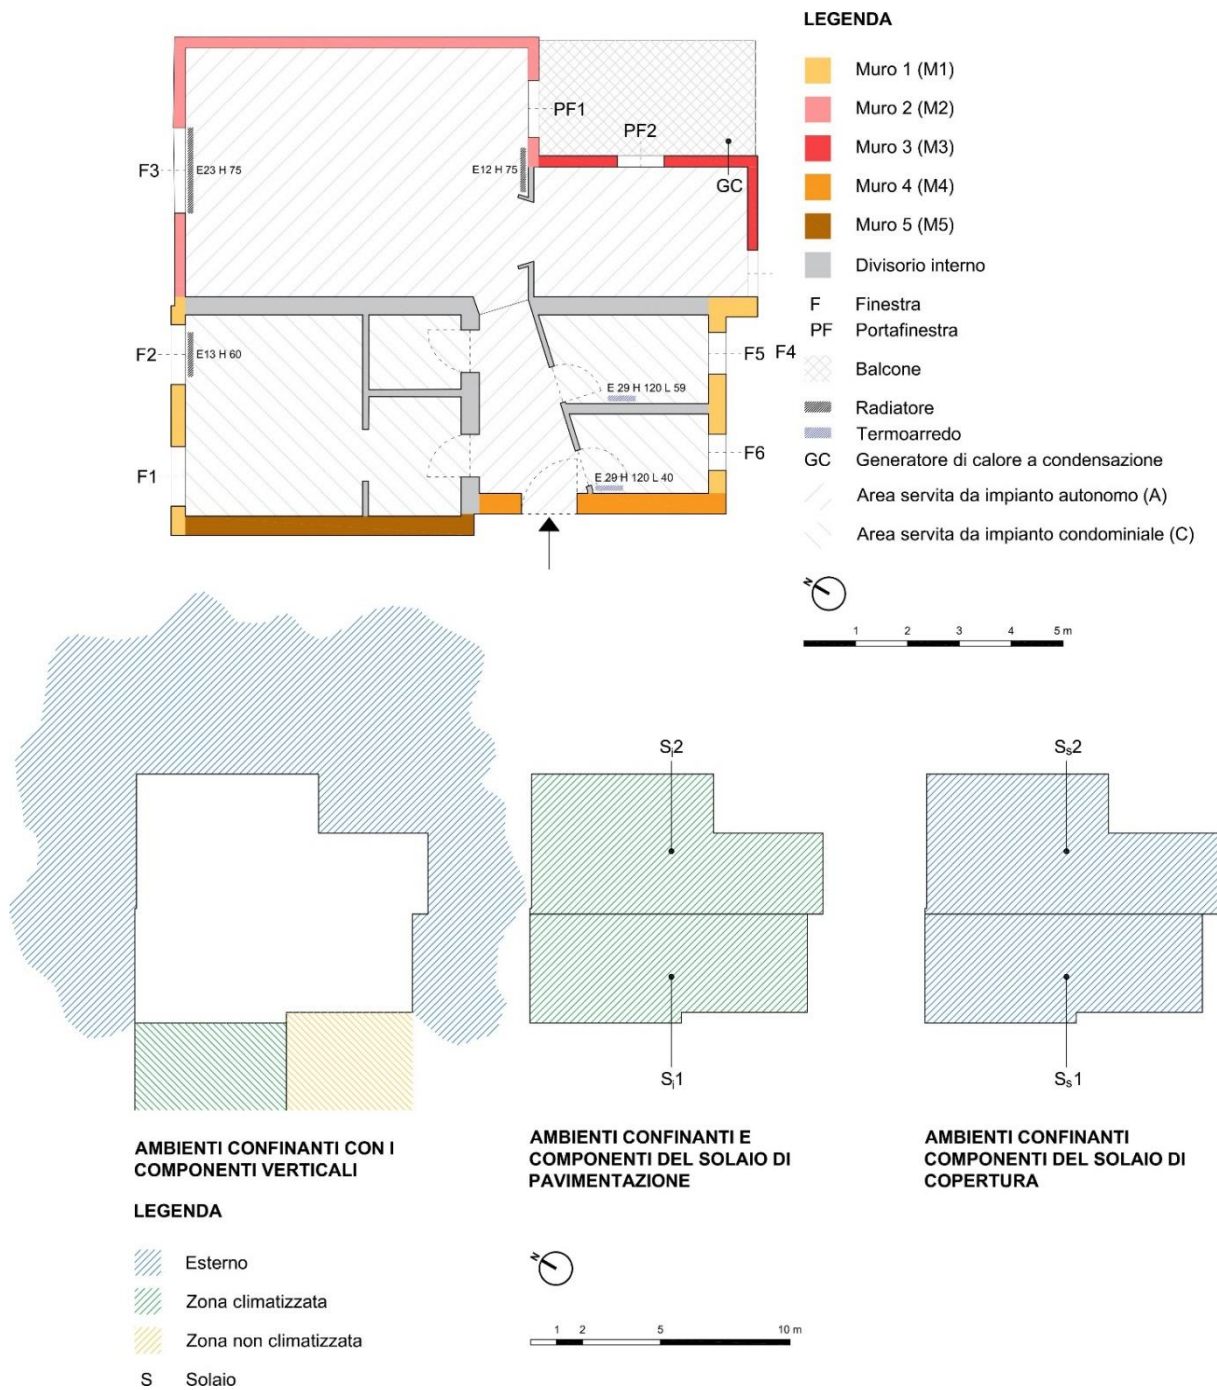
Caratterizzazione geometrica e individuazione delle zone confinanti.
